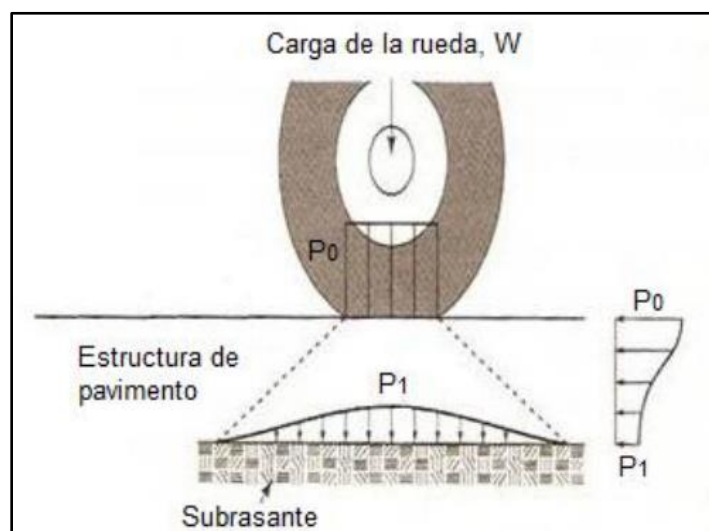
Esfuerzos presentados en pavimentos flexibles
